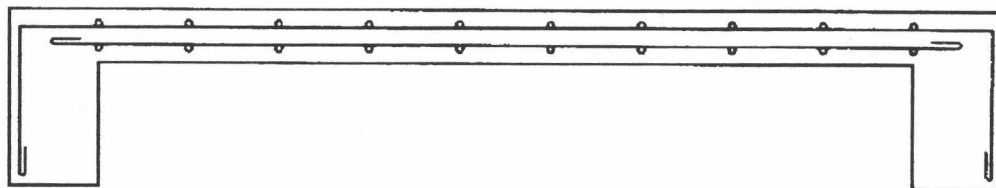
พื้นคอนกรีตช่วงสั้น ถ้าย่น้ำหนักสองทาง (Short Span 2 Way Slab\_SS2WS)
